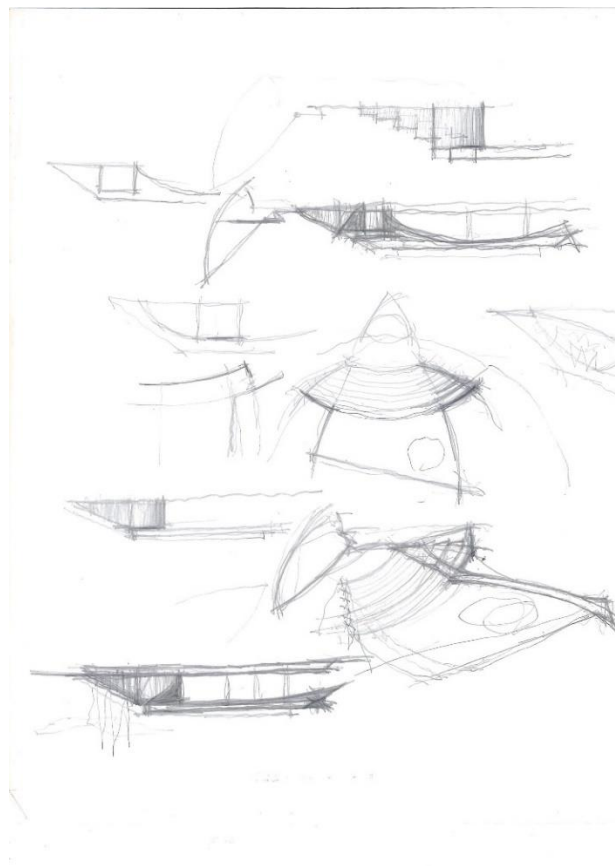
Croqui do arquiteto na concepção do Museu MADI
